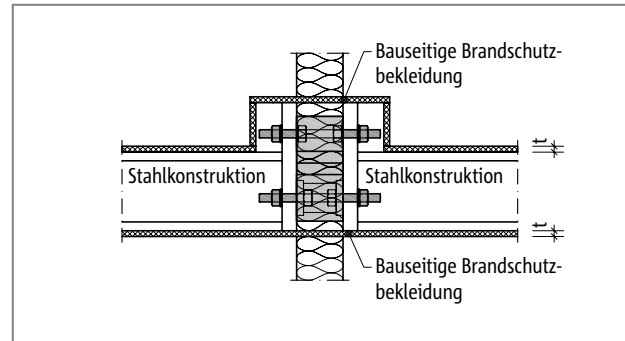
Brandschutz Schöck Isokorb® T Typ S: Bauseitige Brandschutzbekleidung bei überstehenden Stirnplatten; Schnitt
